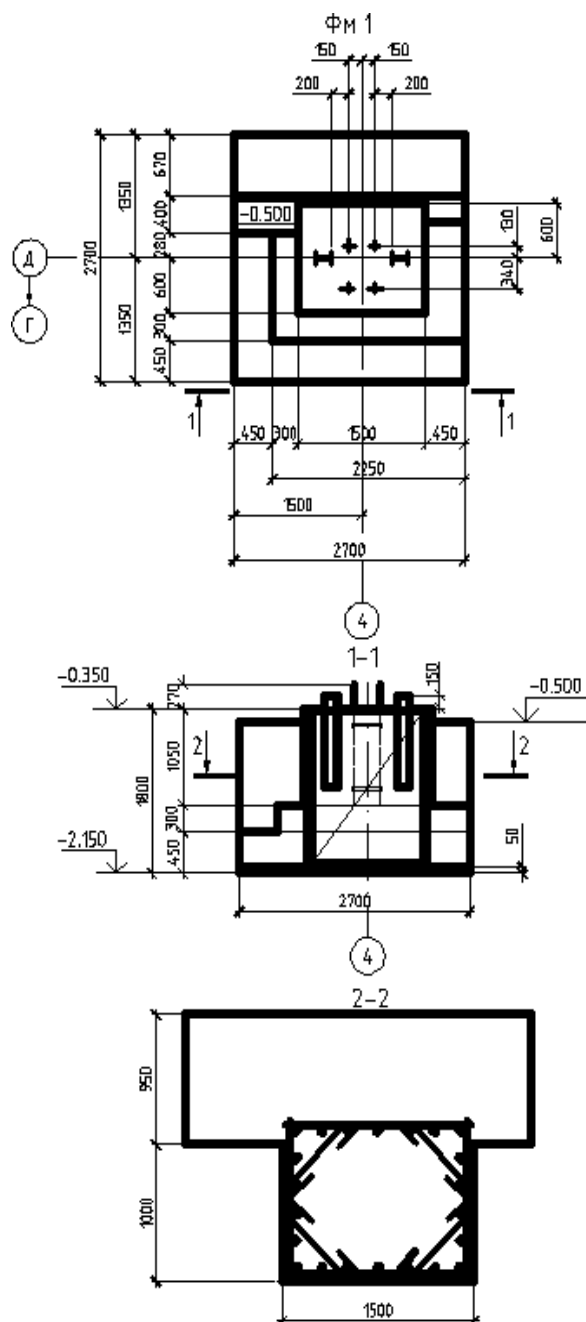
Конструювання стовпчастого фундаменту
